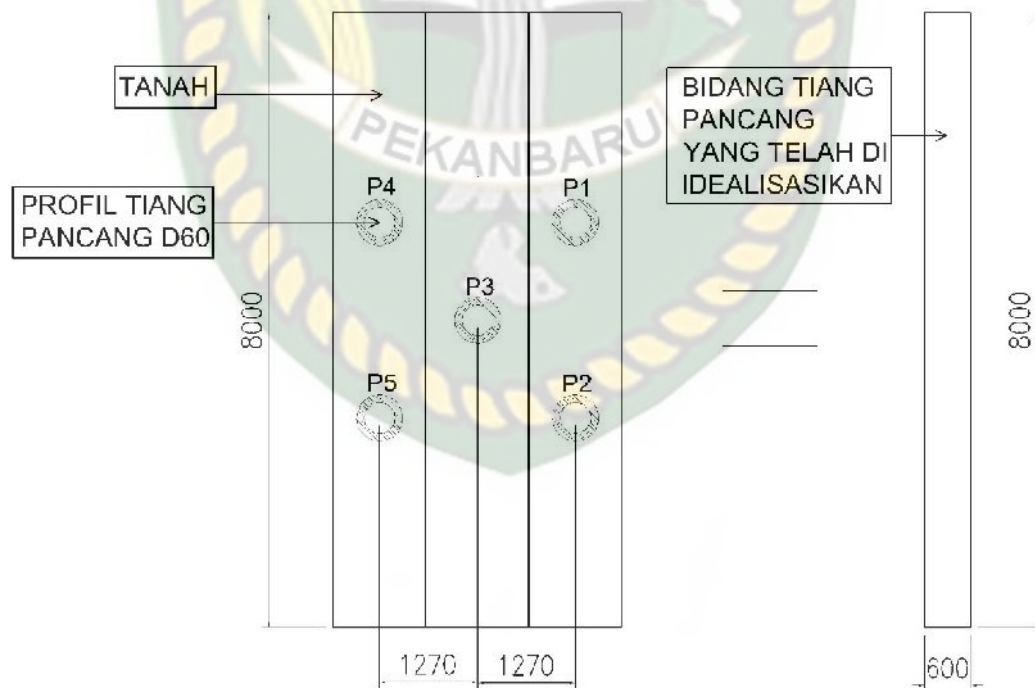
Denah tiang pancang (*Spun pile*)
